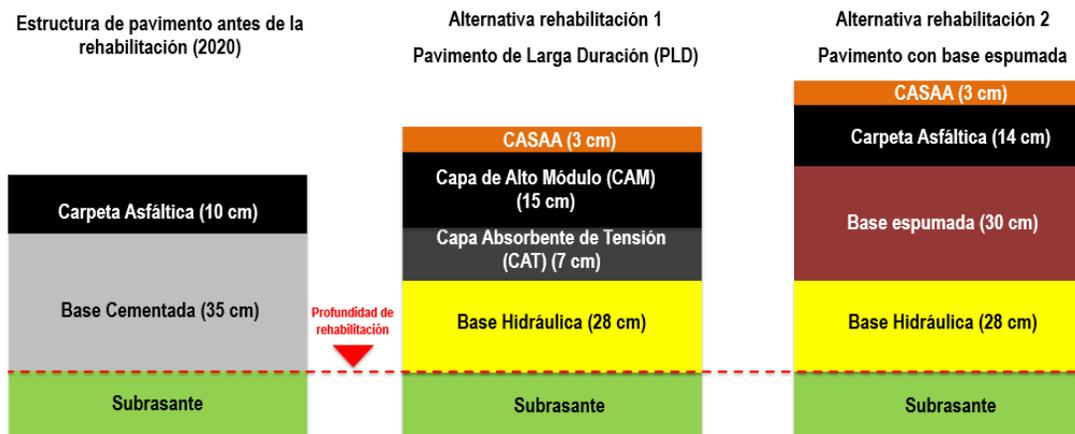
Estructuras de rehabilitación del pavimento para las comparativas de LCA y LCCA.
